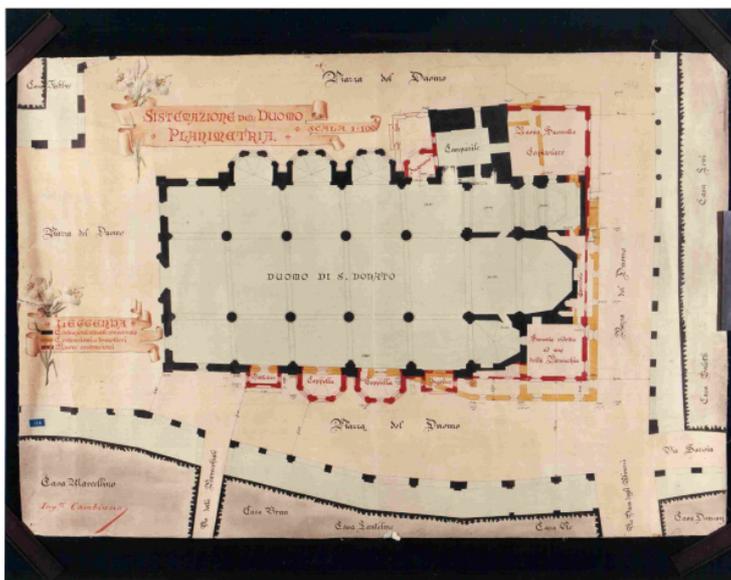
Sistemazione della Cattedrale con realizzazione delle tre cappelle e delle nuove sacrestie su progetto dell'Ingegnere Stefano Cambiano
